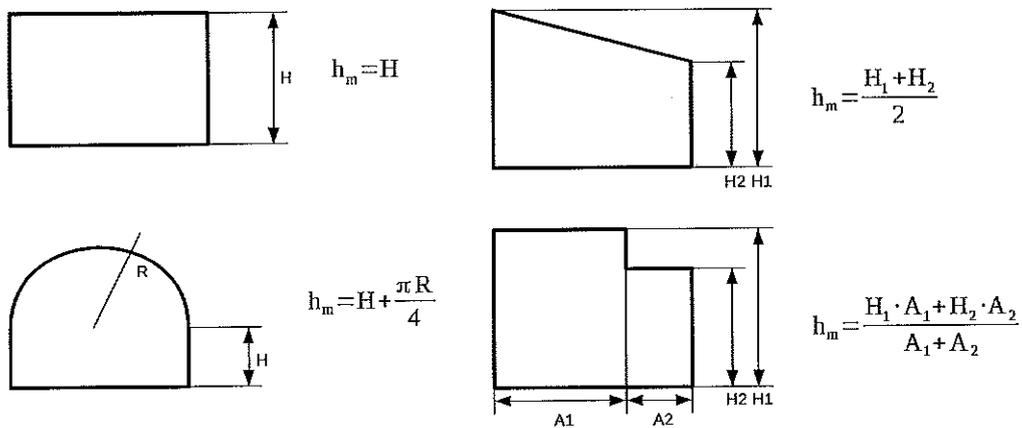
Esempi di determinazione dell'altezza media, in sezione
